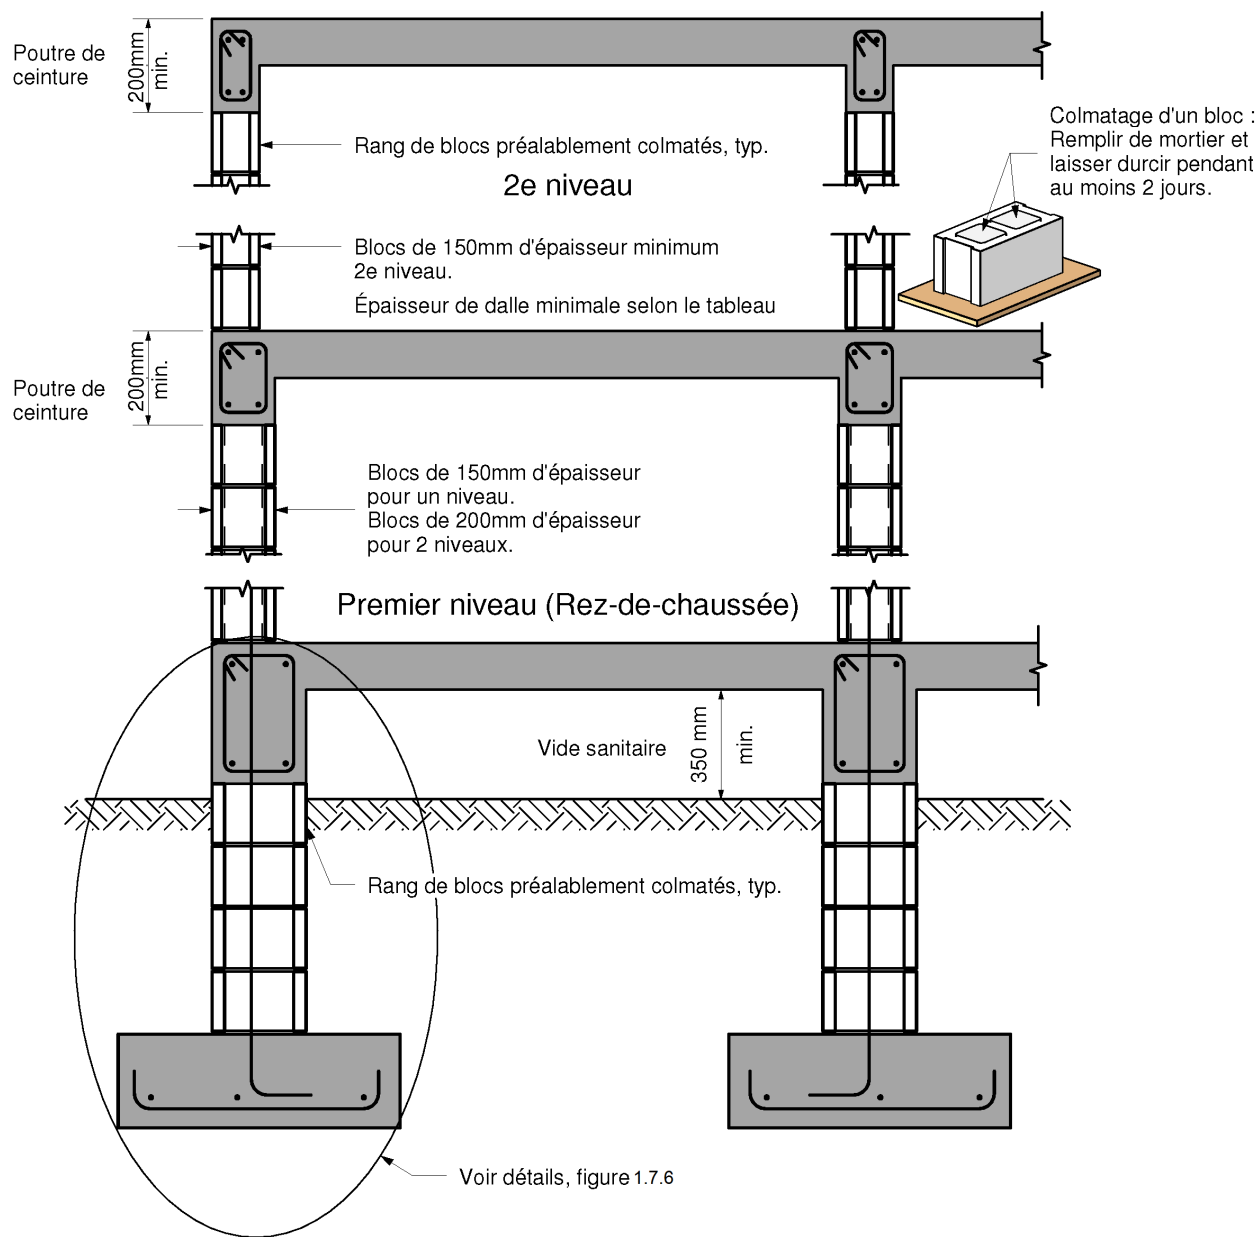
a - Emplacement des poutres de ceinture
